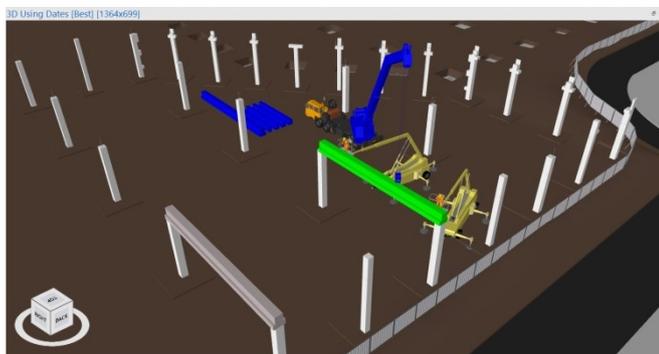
Impostazione delle fasi di cantiere su Synchro; fase di montaggio travi prefabbricate.
